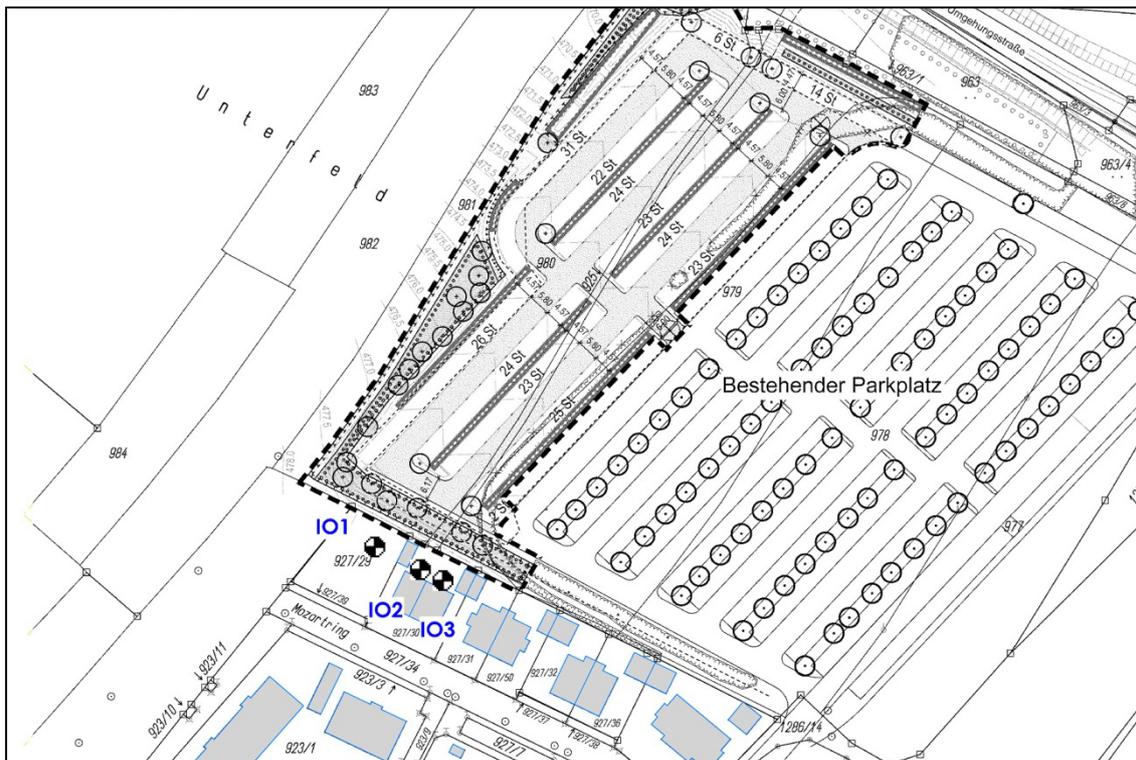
Lageplan mit Eintragung der maßgeblichen Immissionsorte (IO)
